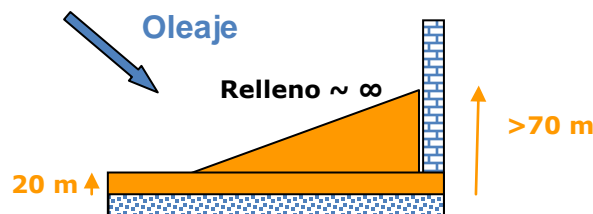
Esquema de construcción de playas encajadas para un ancho máximo de playa seca >70 m
